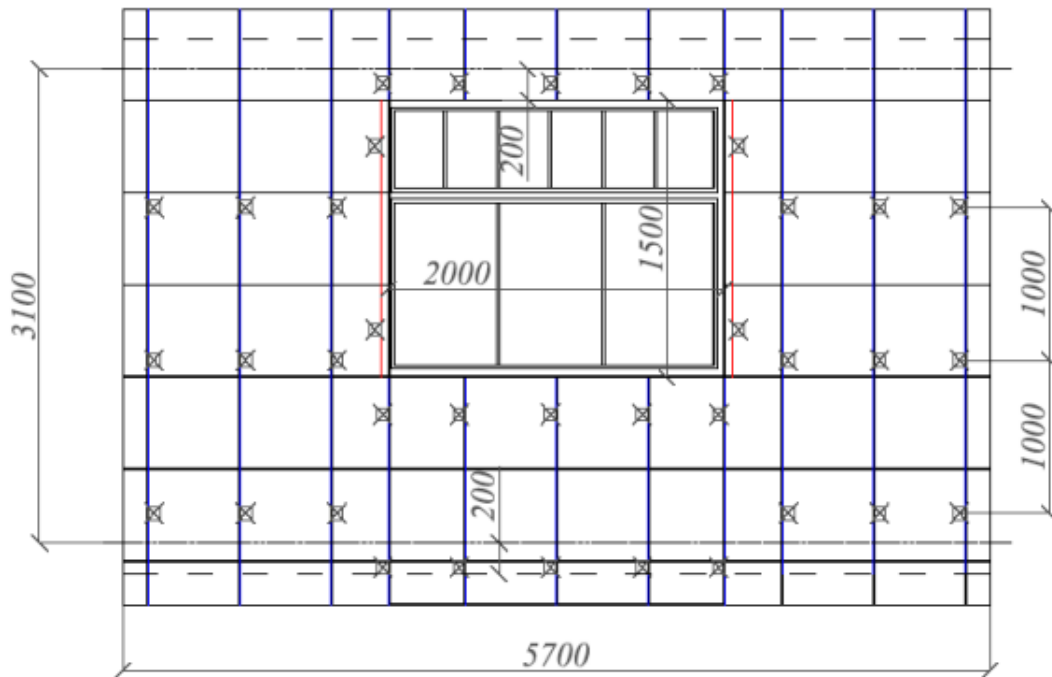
Фрагмент фасаду для розрахунку
